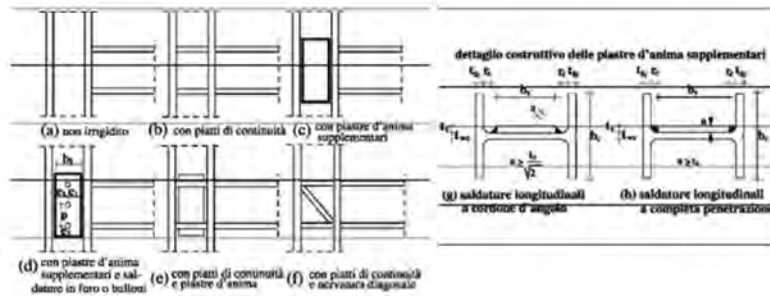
Dettagli costruttivi di pannelli nodali irrigiditi
